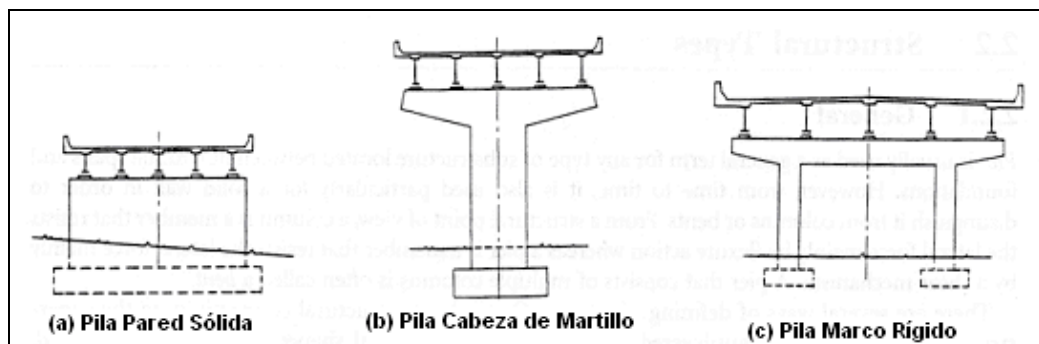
Tipos de pilas típicas para puentes de acero.
